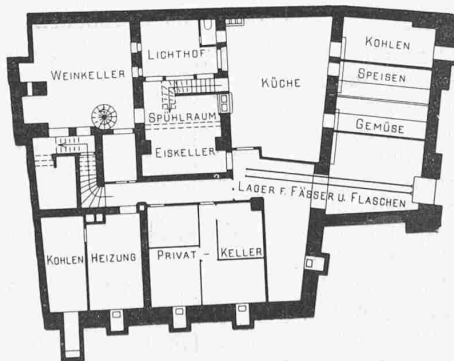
Grundriss vom Kellergeschoss. 1 : 400.
